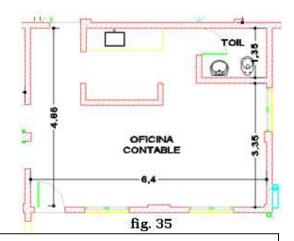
y fig. 35 – Sector de Oficinas Contables, tipo de lluminación y plano en Planta (fig. 35).
